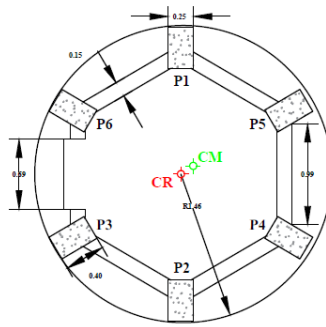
Planta de patamar "cinta de piso" (sem escala)
